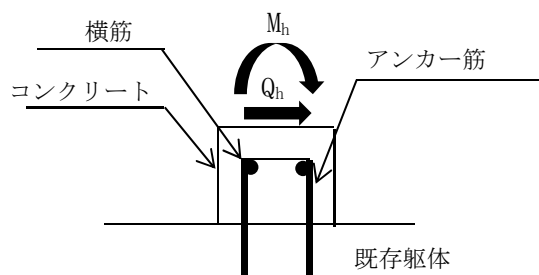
溢水時の鉄筋コンクリート製堰に生じる力の断面概念図(矩形の堰)
